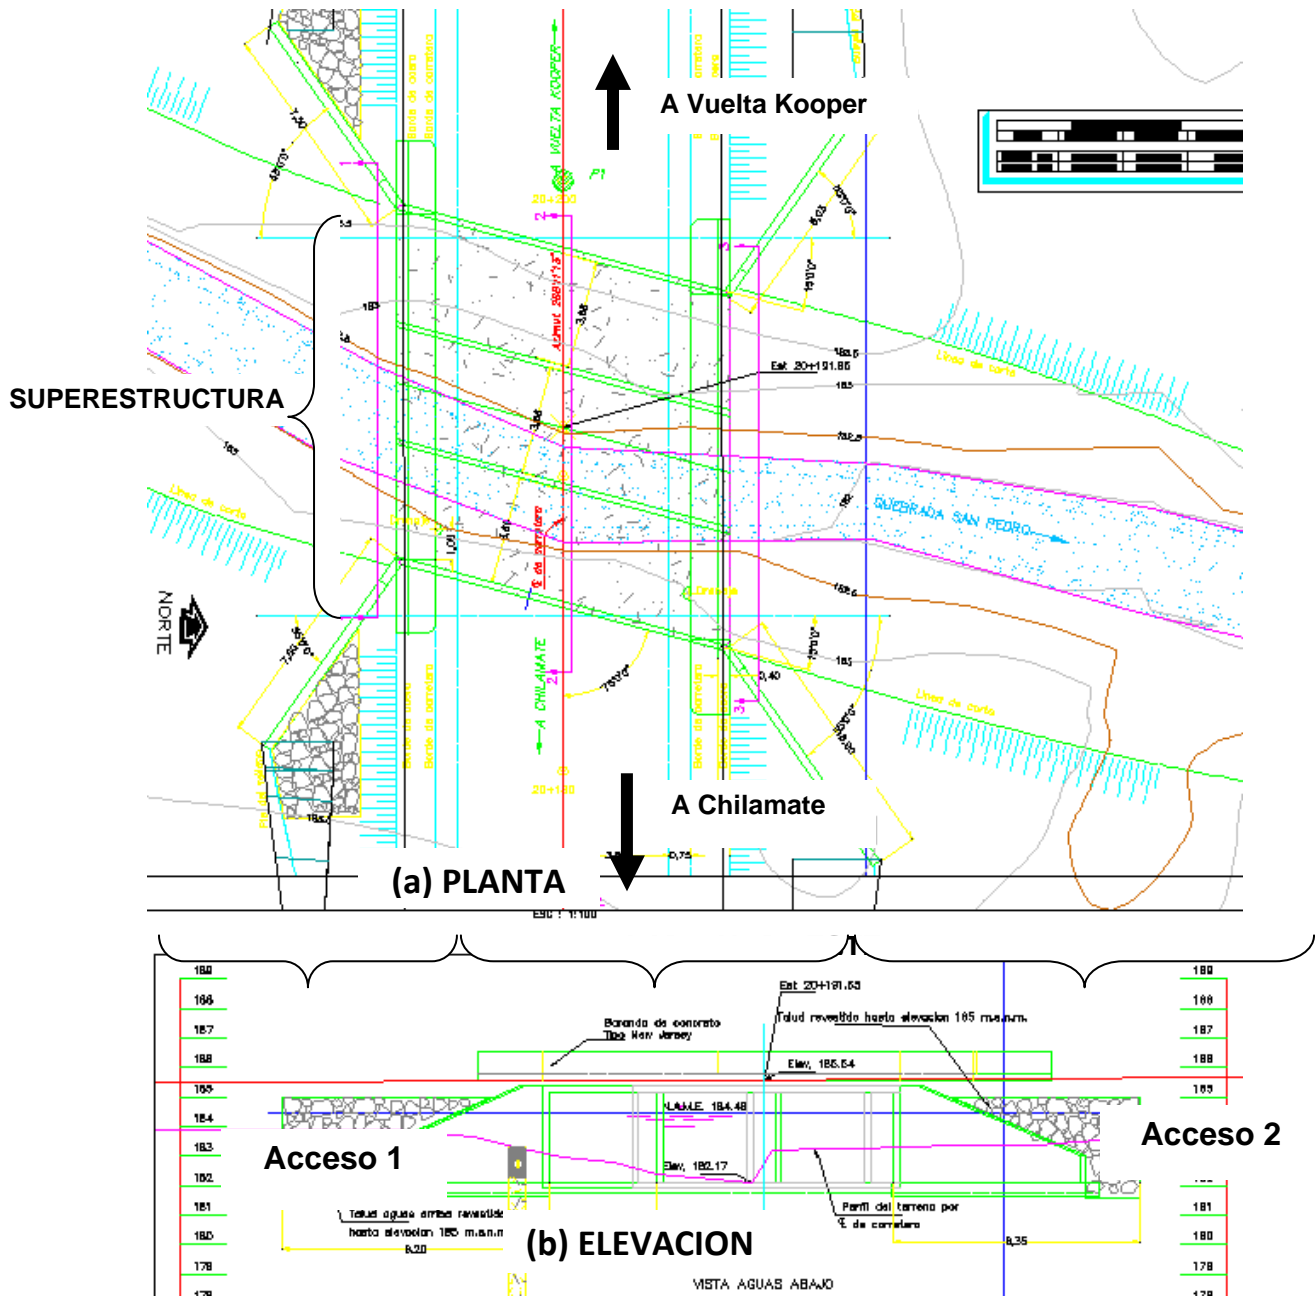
Plano de la alcantarilla sobre la Quebrada San Pedro donde se identifican sus elementos.
